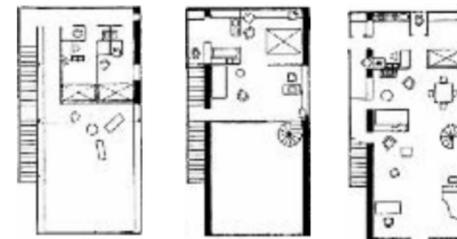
Planta baixa Casa Citrohan, Le Corbusier, 1925.
